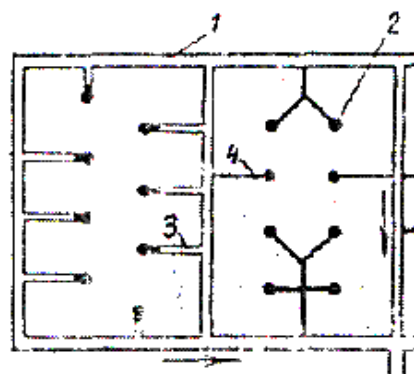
Схема систематического вертикального дренажа: 1 – каналы; 2 – дренажные скважины; 3 – мелкие сбросные каналы с противофильтрационными экранами в оголовках; 4 – напорные закрытые трубопроводы
